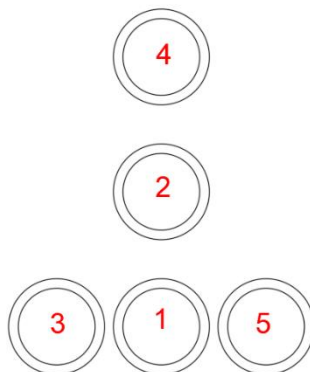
Sezione trasversale del pilastro 1B, con numerazione dei culmi costituenti lo stesso.
